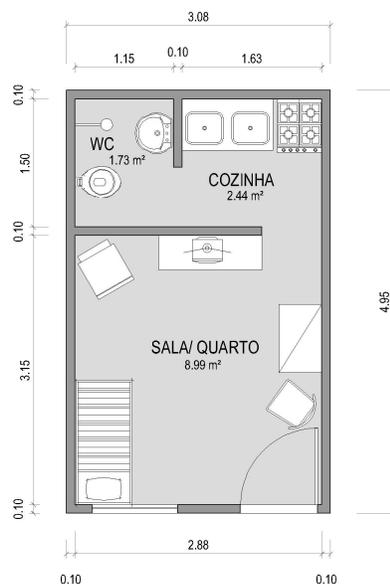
Planta baixa da casa de Marlúcia. Área: 13,16 m².
